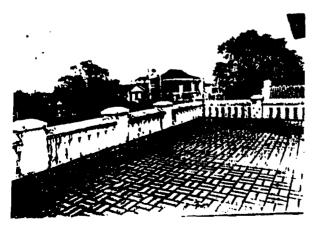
/100357 Kondisi teras lantai balkon bangunan induk, dilihat dari tenggara,
